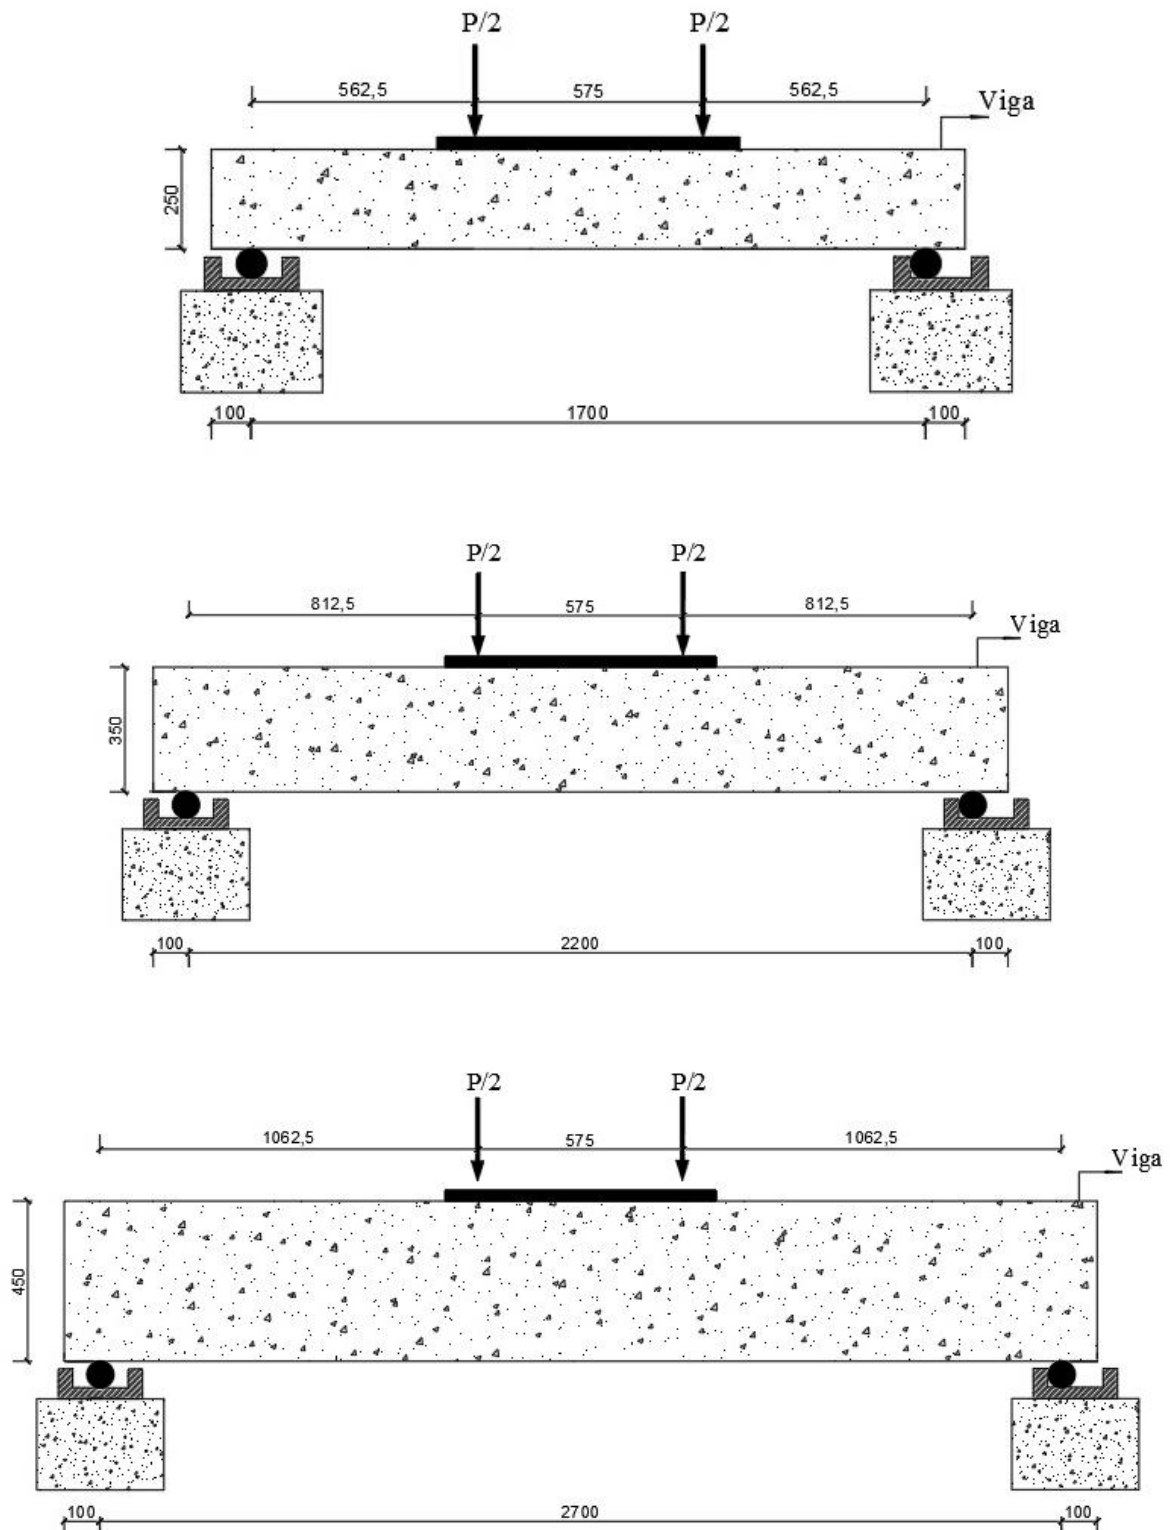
Detalhamento das vigas e configuração do ensaio. Fonte: Autora
